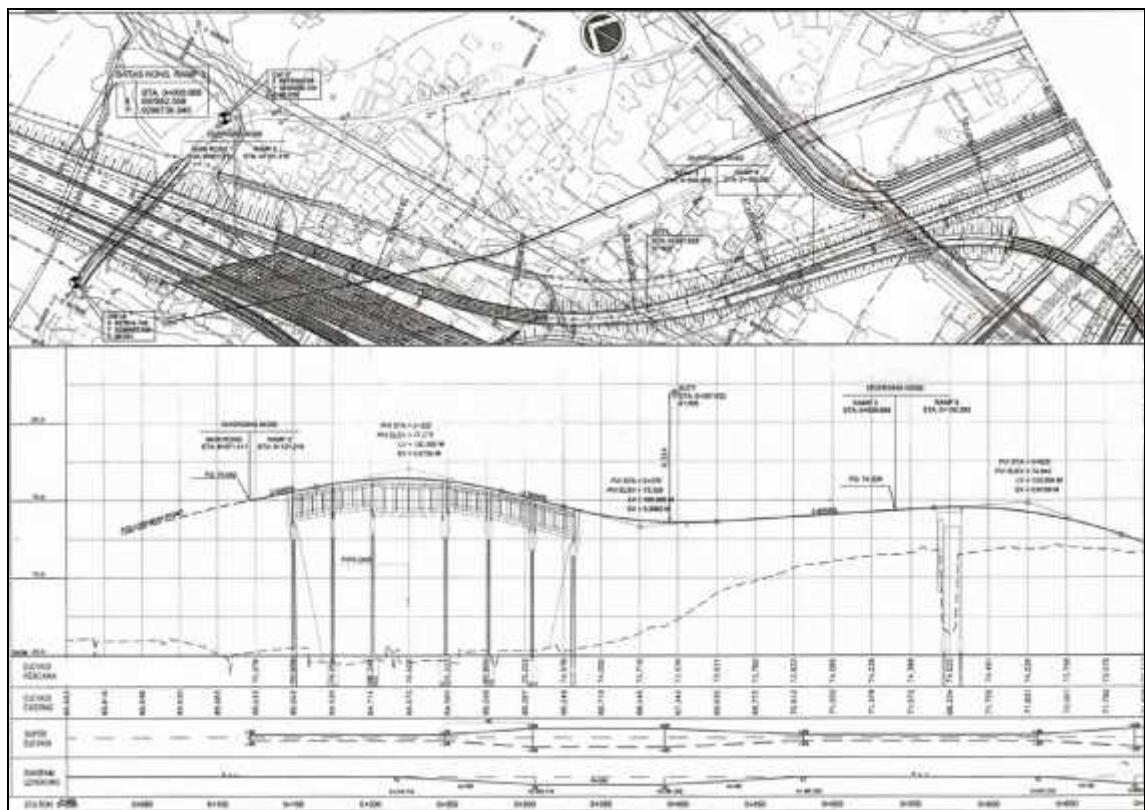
Potongan Memanjang *Mainroad* Jalan Tol Ruas Depok – Antasari Sta. 7+800 sampai Sta. 9+000
